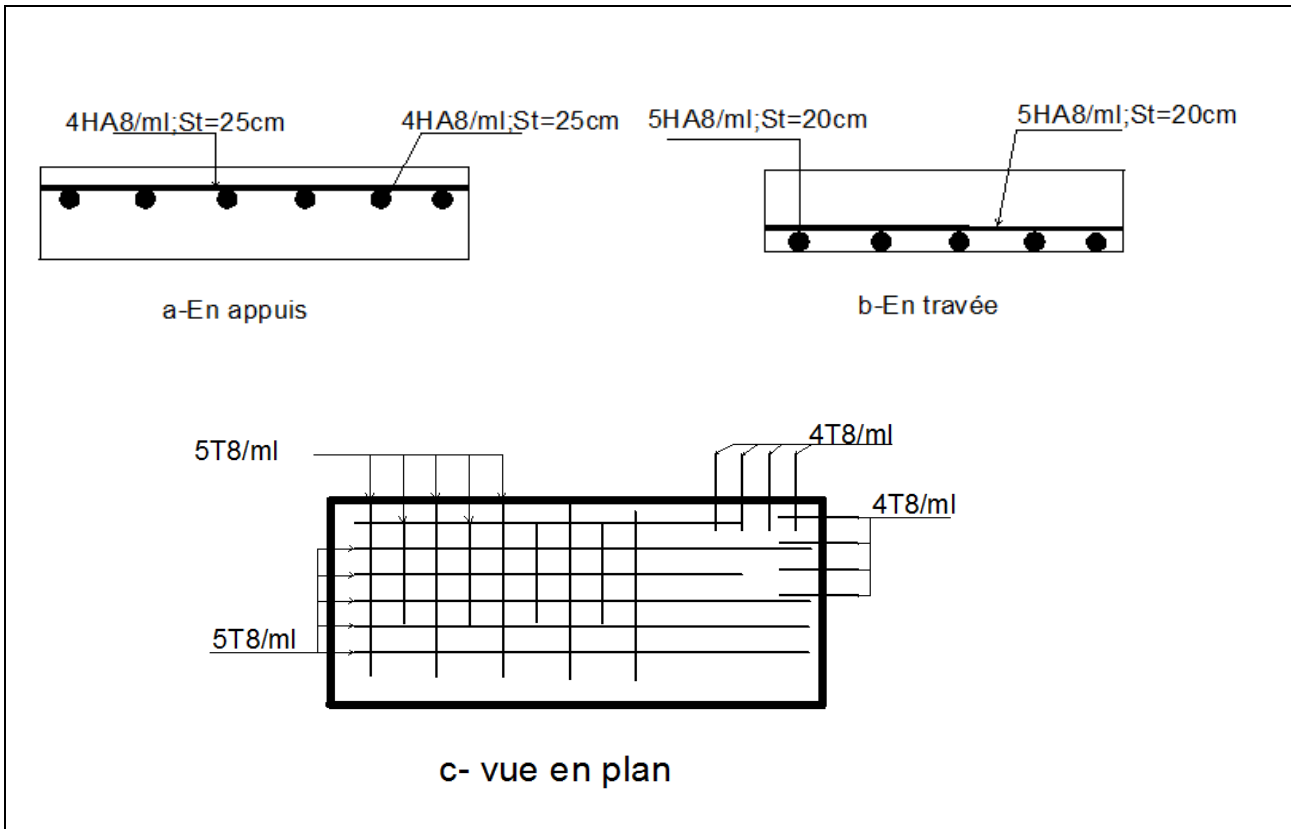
Schéma de ferrailage de la dalle sur quatre appuis.
